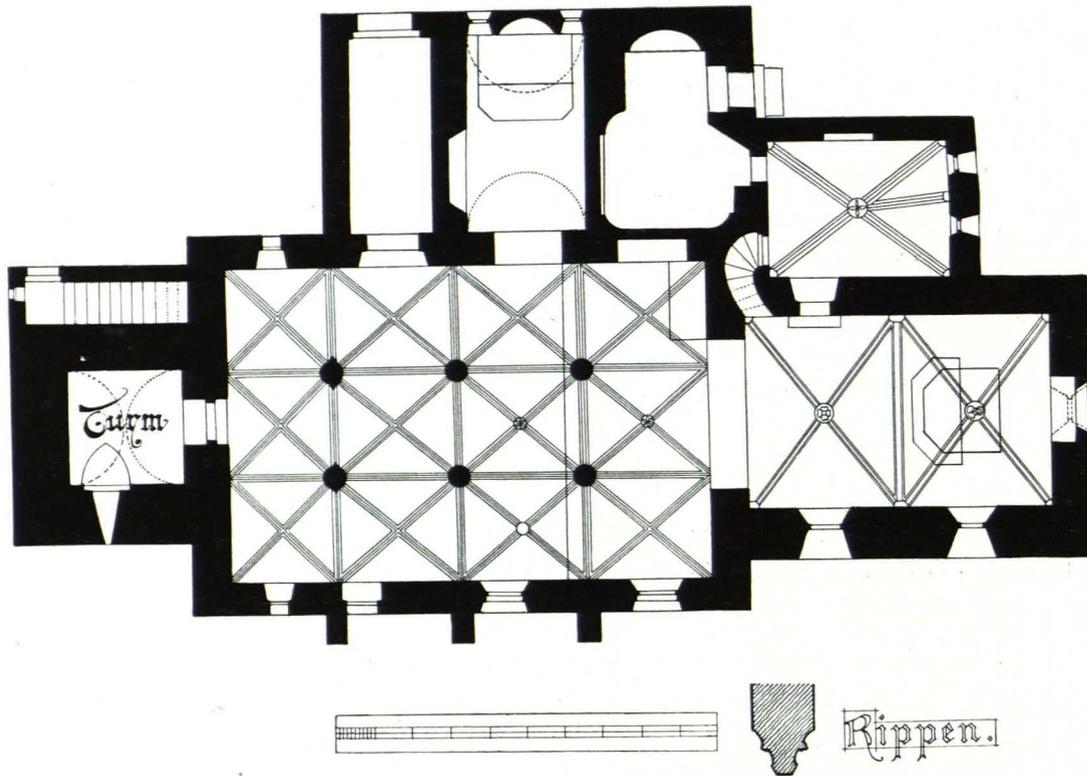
Münichreith, Pfarrkirche, Grundriß 1 : 200 (S. 119)
